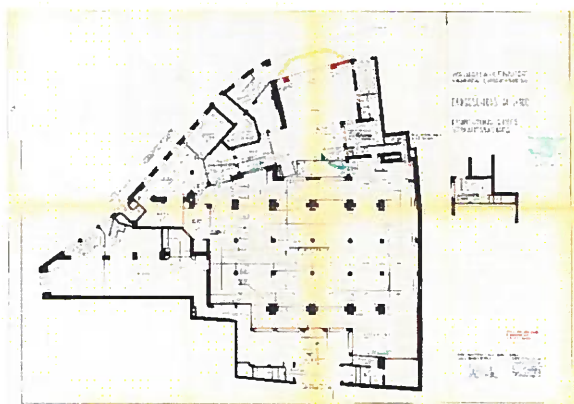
Antragsplanung: Verkaufsnutzung im Erdgeschoss, Bauakte Stadt Wiesbaden
